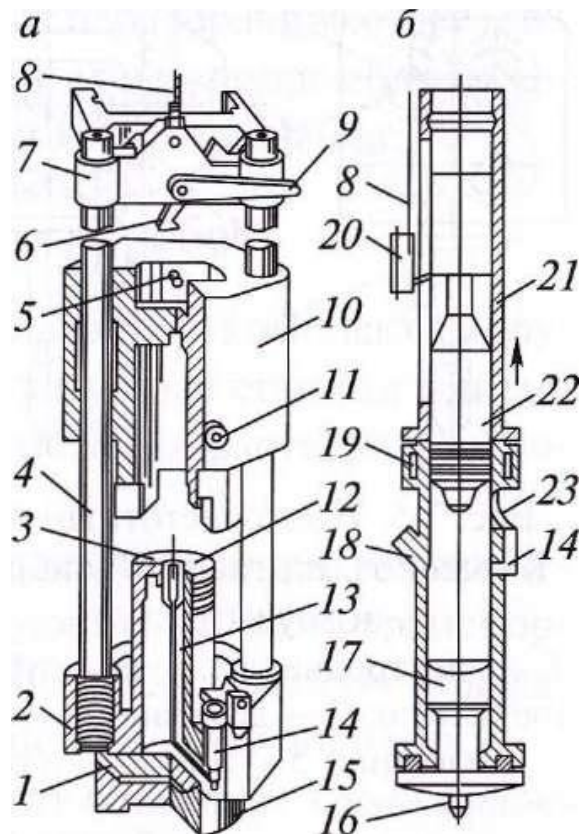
Дизель-молоты: а — штанговый, б — трубчатый; 1 — сферическая плита; 2 — основание; 3 — форсунка; 4 — две направляющие штанги; 5 — па-лец; 6 — под-пружиненный крюк; 7 — траверса; 8 — канат лебедки; 9 — рычаг; 10 — цилиндр; 11 — штырь; 12 — поршень; 13 — цен-тральный канал; 14 — топлив-ный насос; 15 — наго-ловник; 16 — центрирующий штырь; 17 — полость шабота; 18 — канал уда-ления от-работанных газов; 19 — канал, 20 — «кошка»; 21 — на-правляющий цилиндр; 22 — пор-шень; 23 — рычаг
